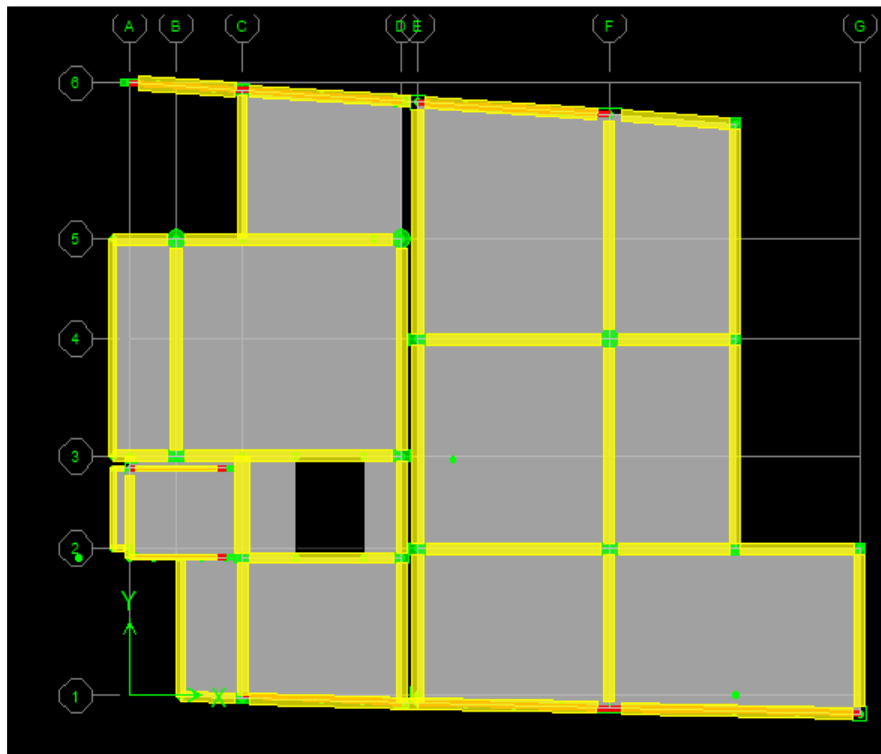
Planta del piso típico 1-4 nivel (Modelo Etabs)
